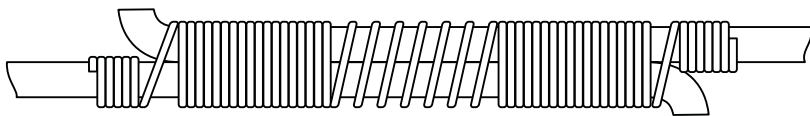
Бандажное соединение стальных однопроволочных проводов
